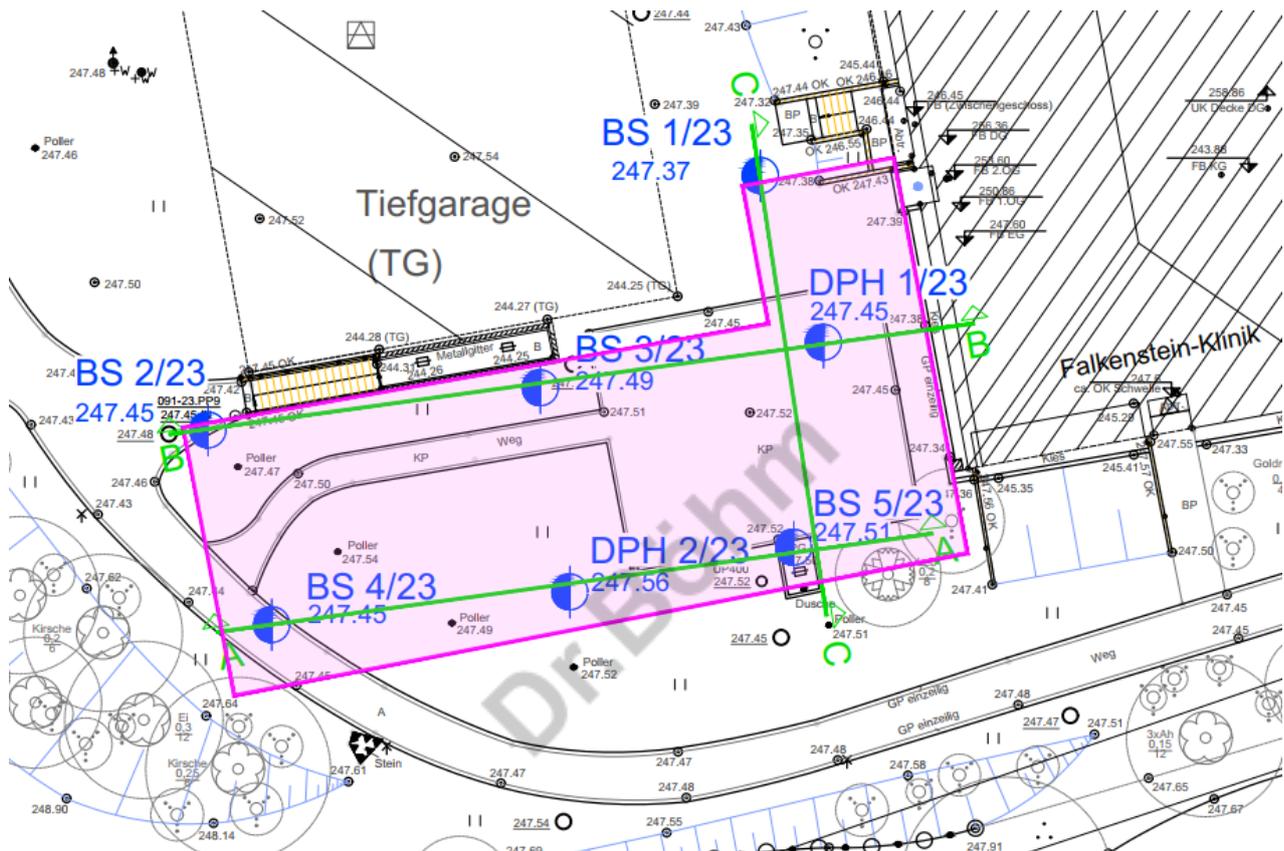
Lageplan Untersuchungsgebiet mit Aufschlusspunkten
